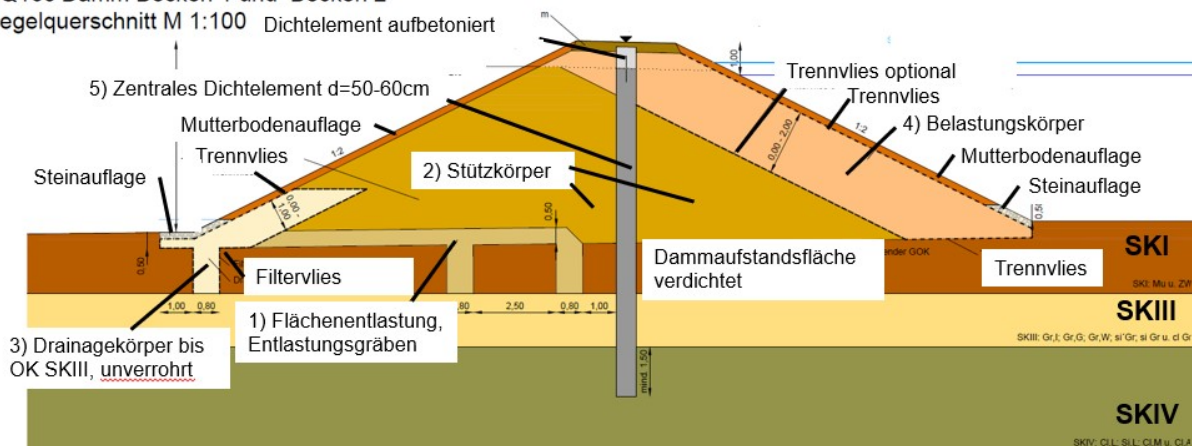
Detaillierter Dammaufbau, beispielhaft für RQ16c (Becken 1 und Becken 2) für bis in den Stauer einbindende Dichtwand aus [17]
